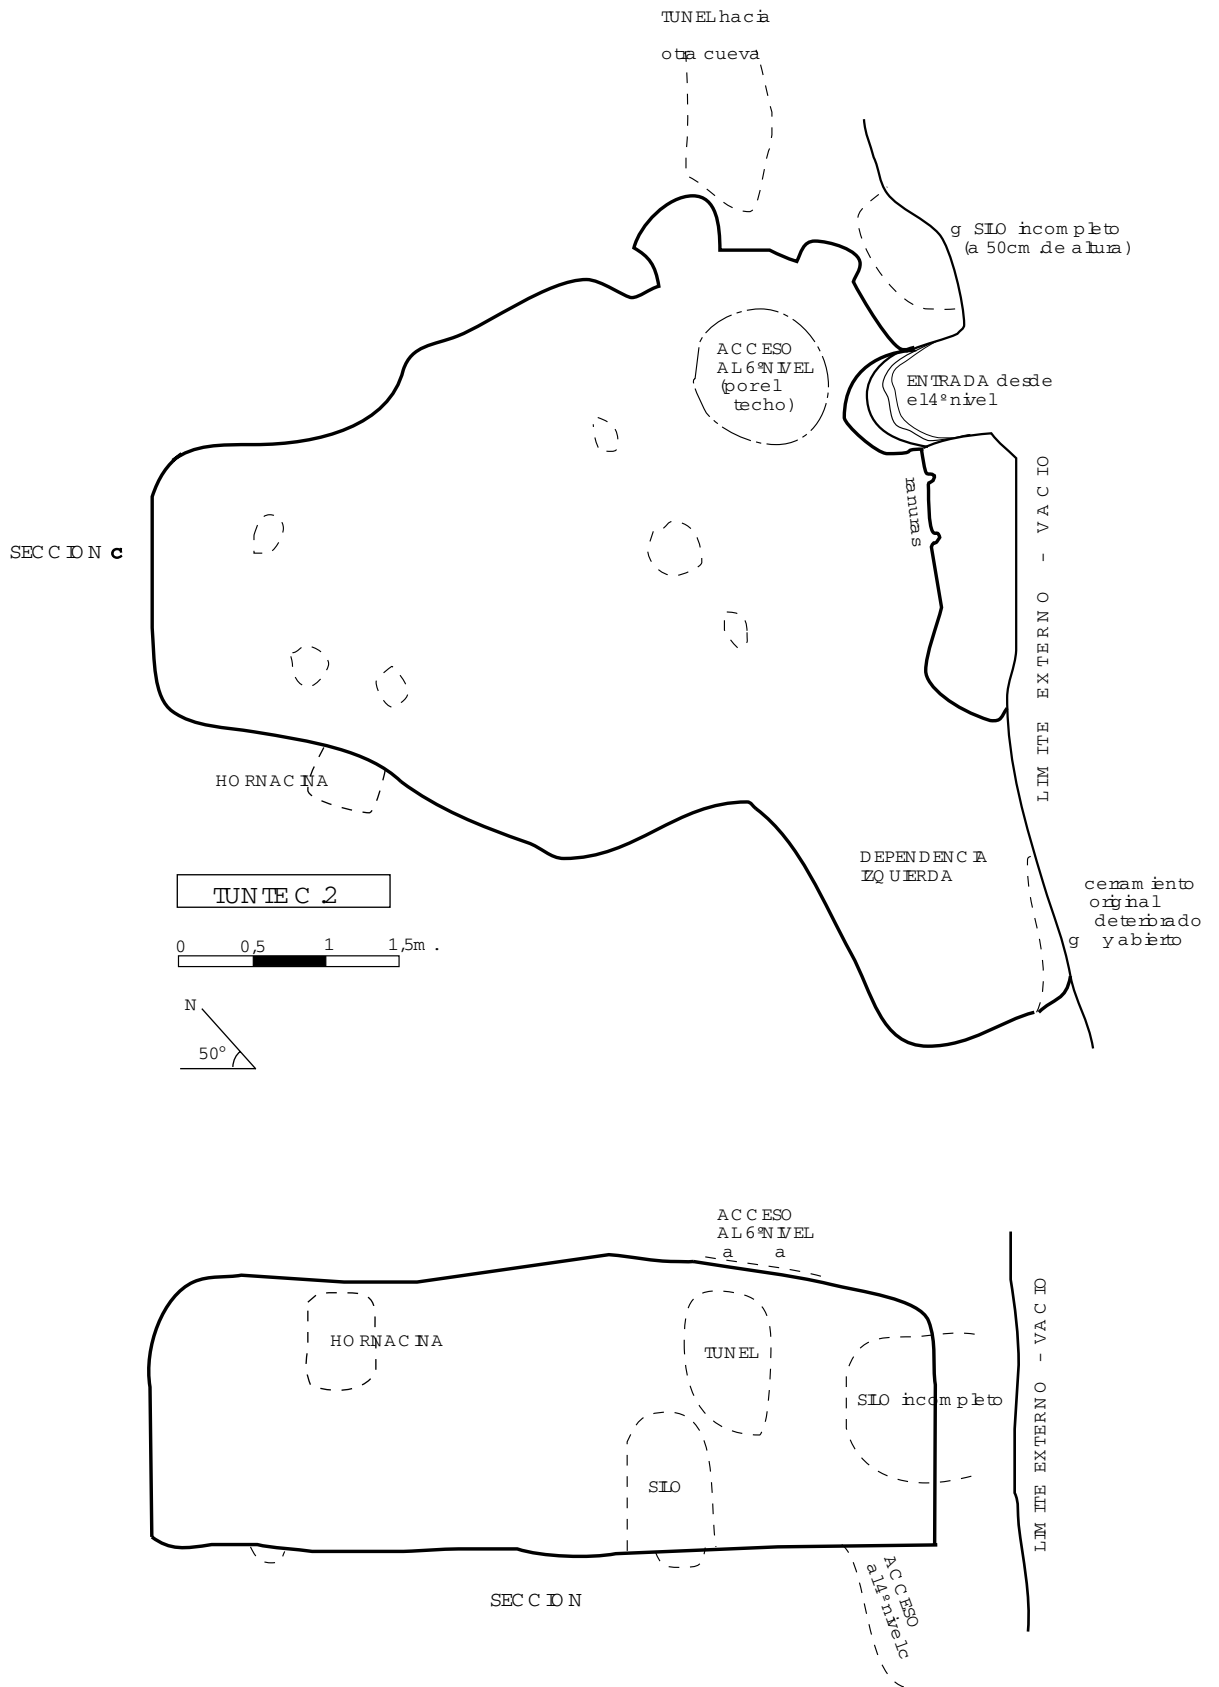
TUNTEC 2: PLANTA Y SECCION
